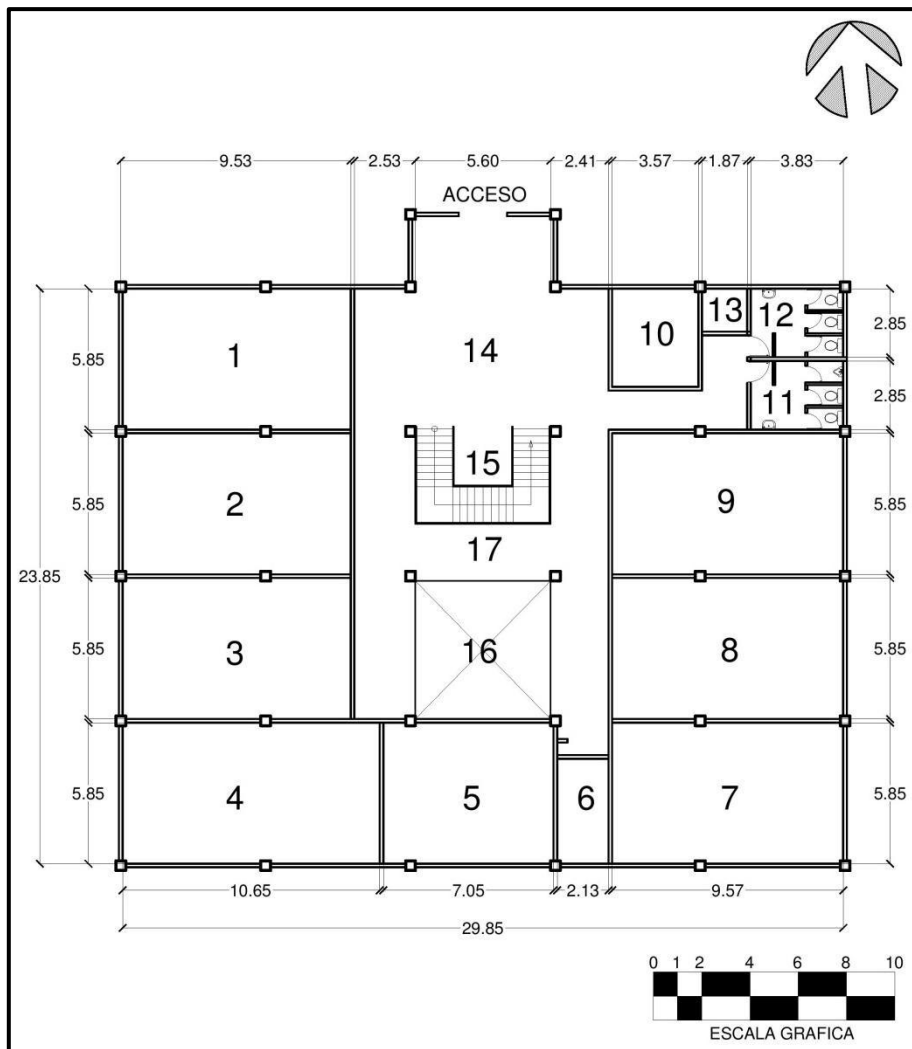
PLANTA ARQUITECTÓNICA 1er NIVEL EDIFICIO DE QUÍMICA
